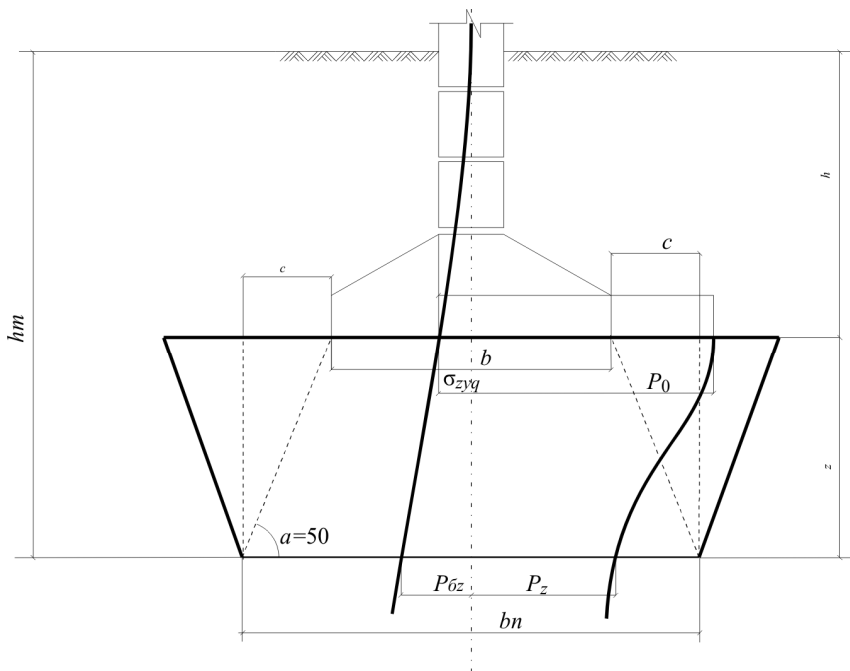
Розрахункова схема для визначення розмірів ґрунтової подушки
